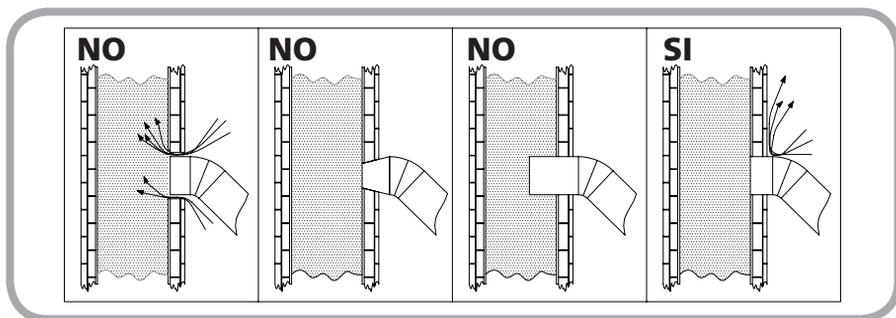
Esempi di corretto e scorretto allacciamento alla canna fumaria
